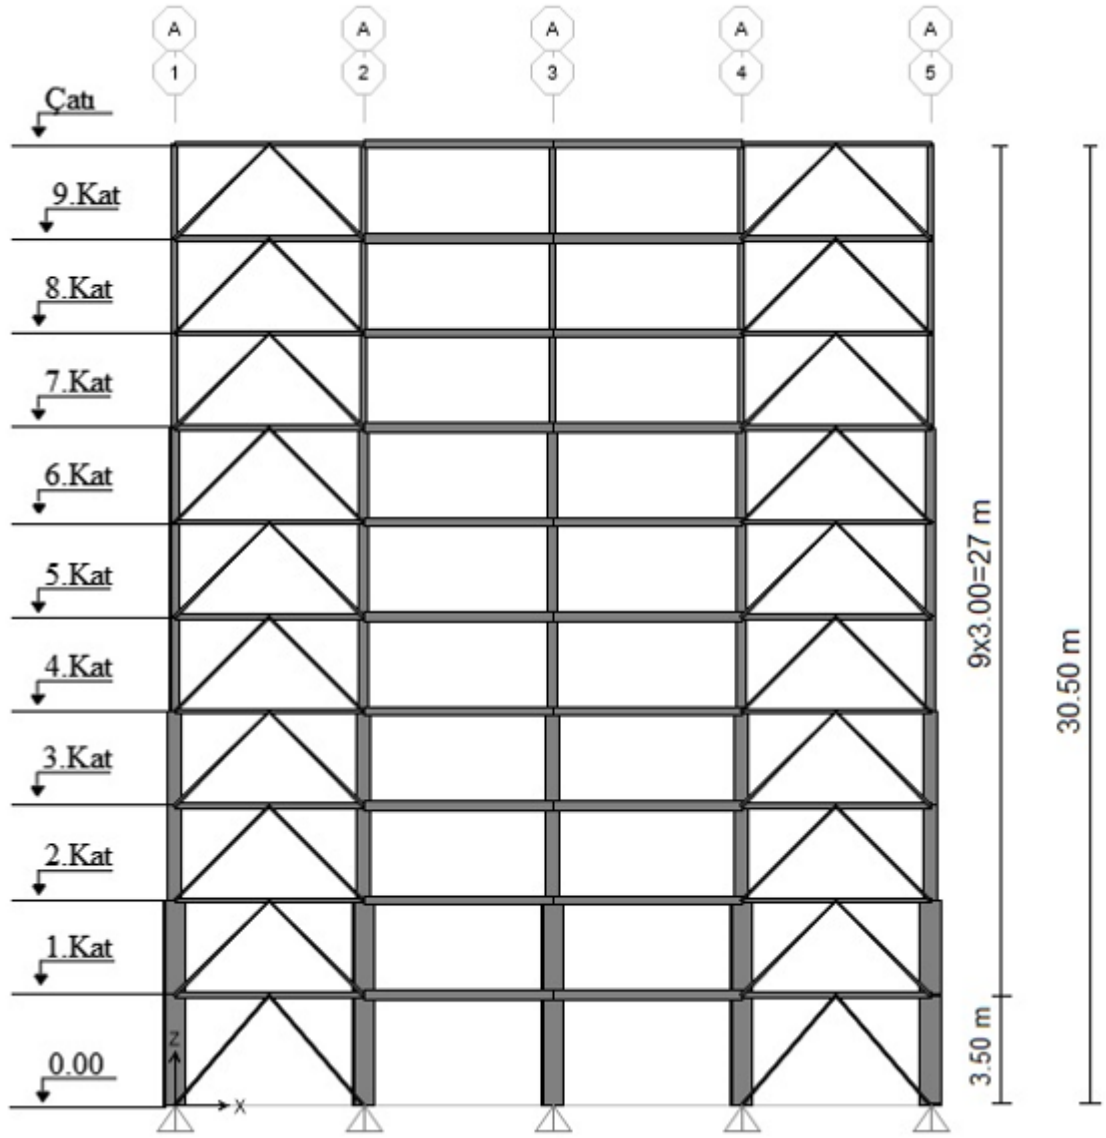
5 ve 10 katlı yapının şematik plan görünüşü
